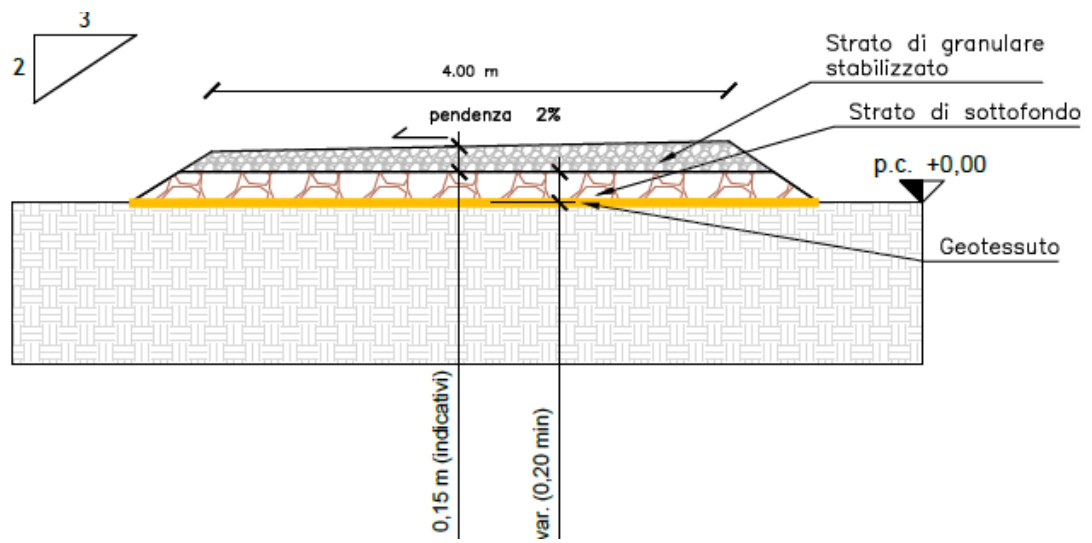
Tipologico sezione stradale viabilità d'impianto.
